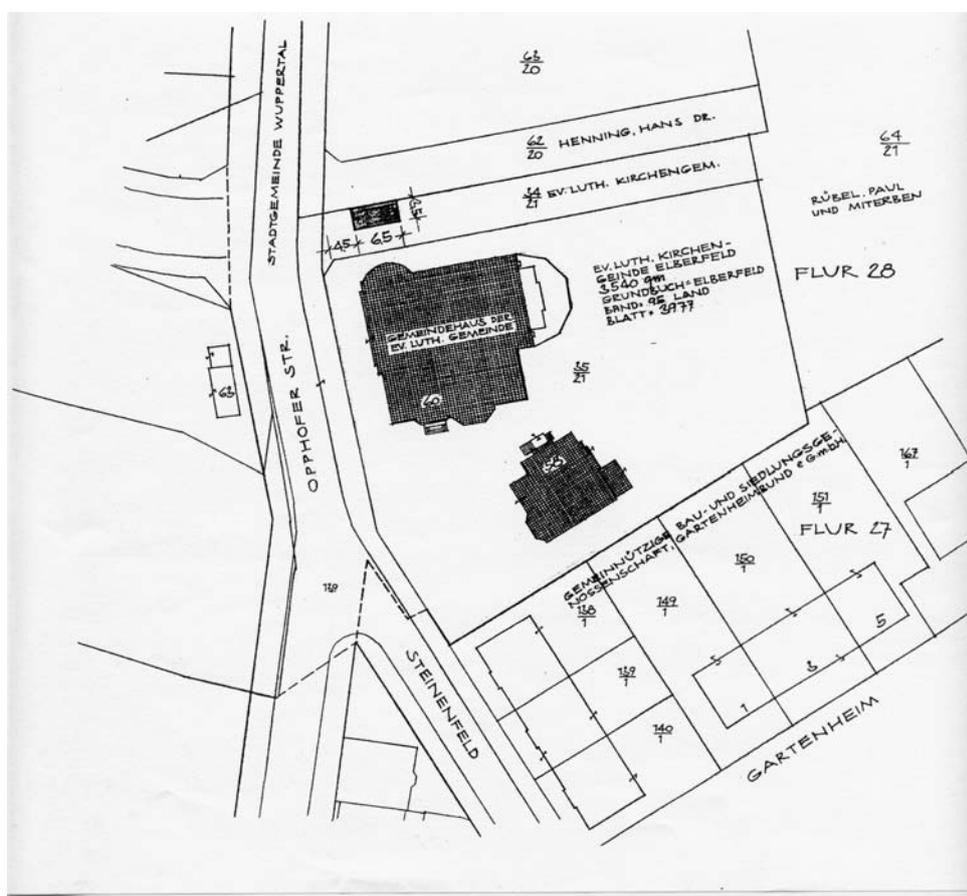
Lageplan mit Pfarrhaus und Einzeichnung der Veränderung der Apsis zum Halbrund, o.J., vermutlich 1960
